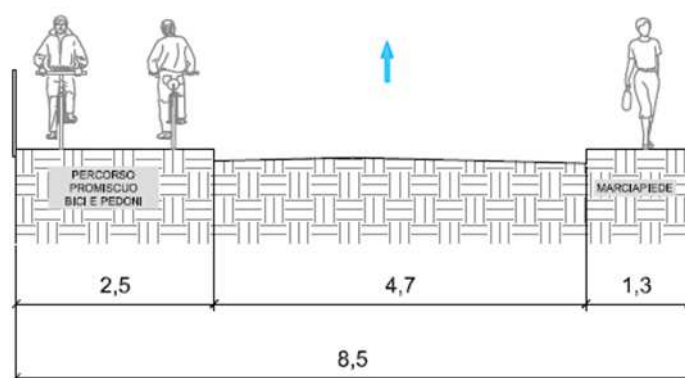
Sezione tipo Ponte Ipazia – stato di progetto (1)
